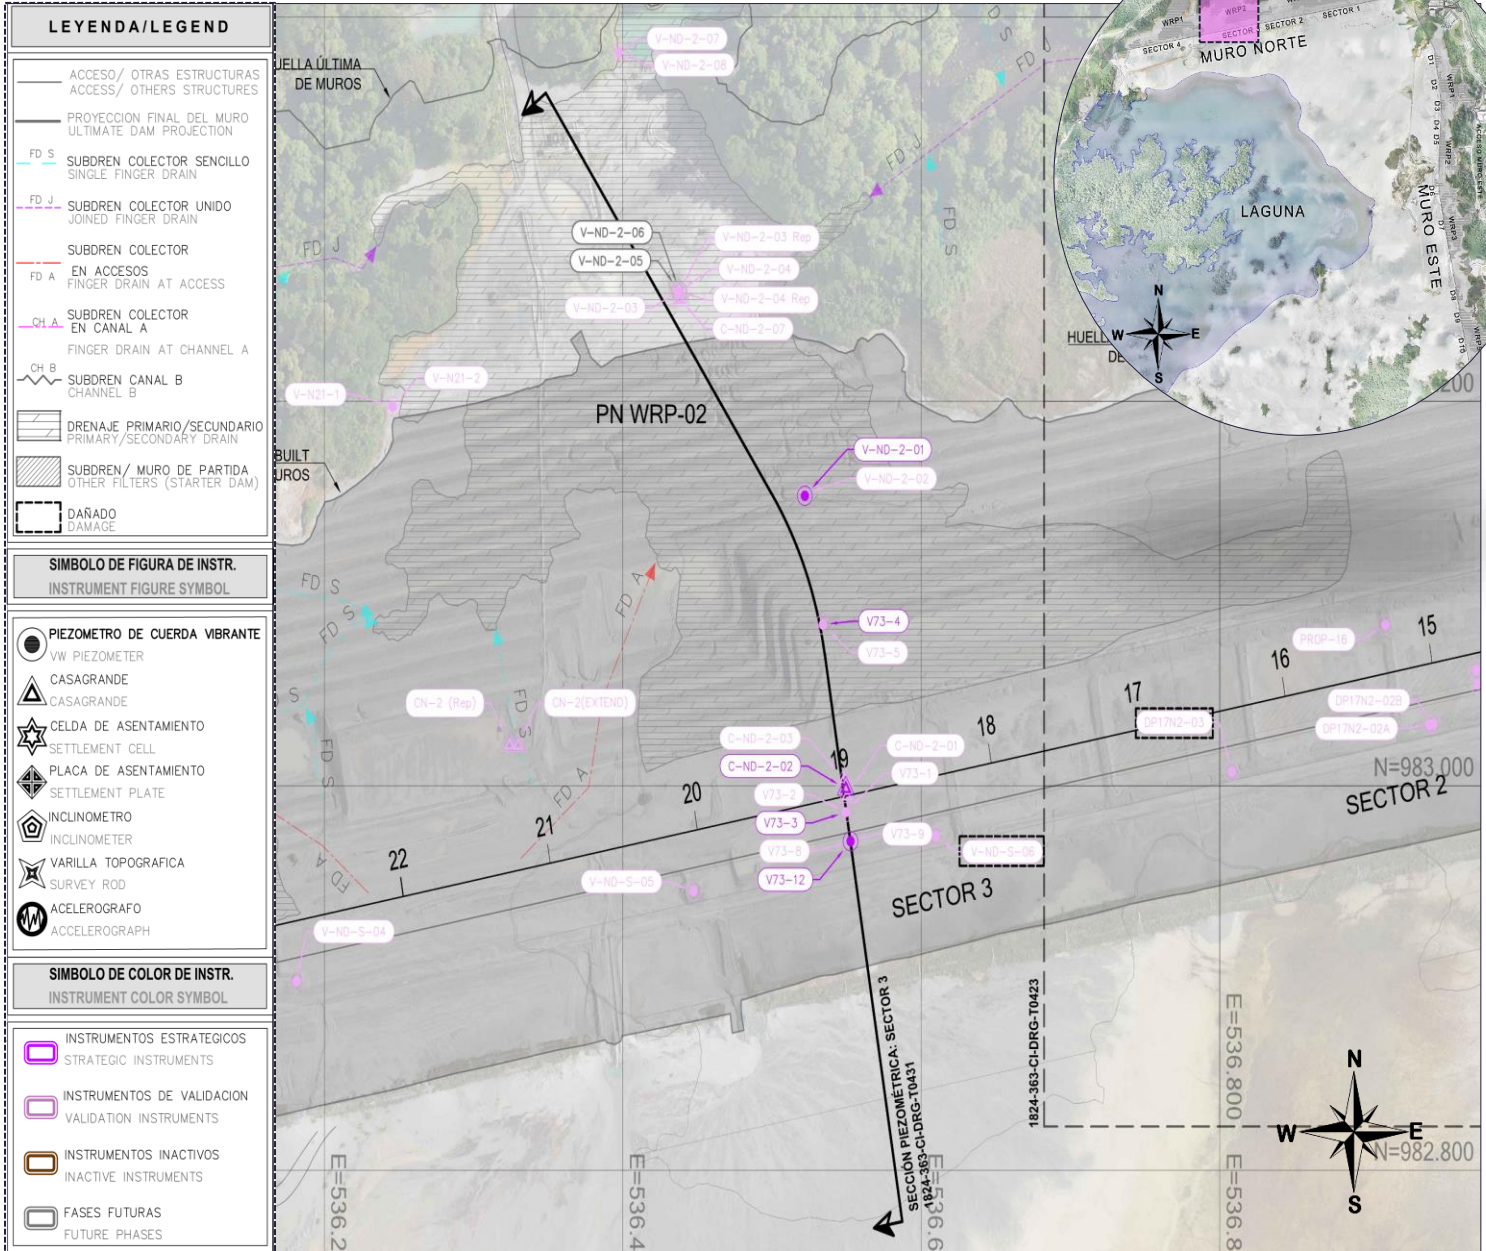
Vista de Planta en Muro Norte Sector 3 - WRP2 con Piezómetros
